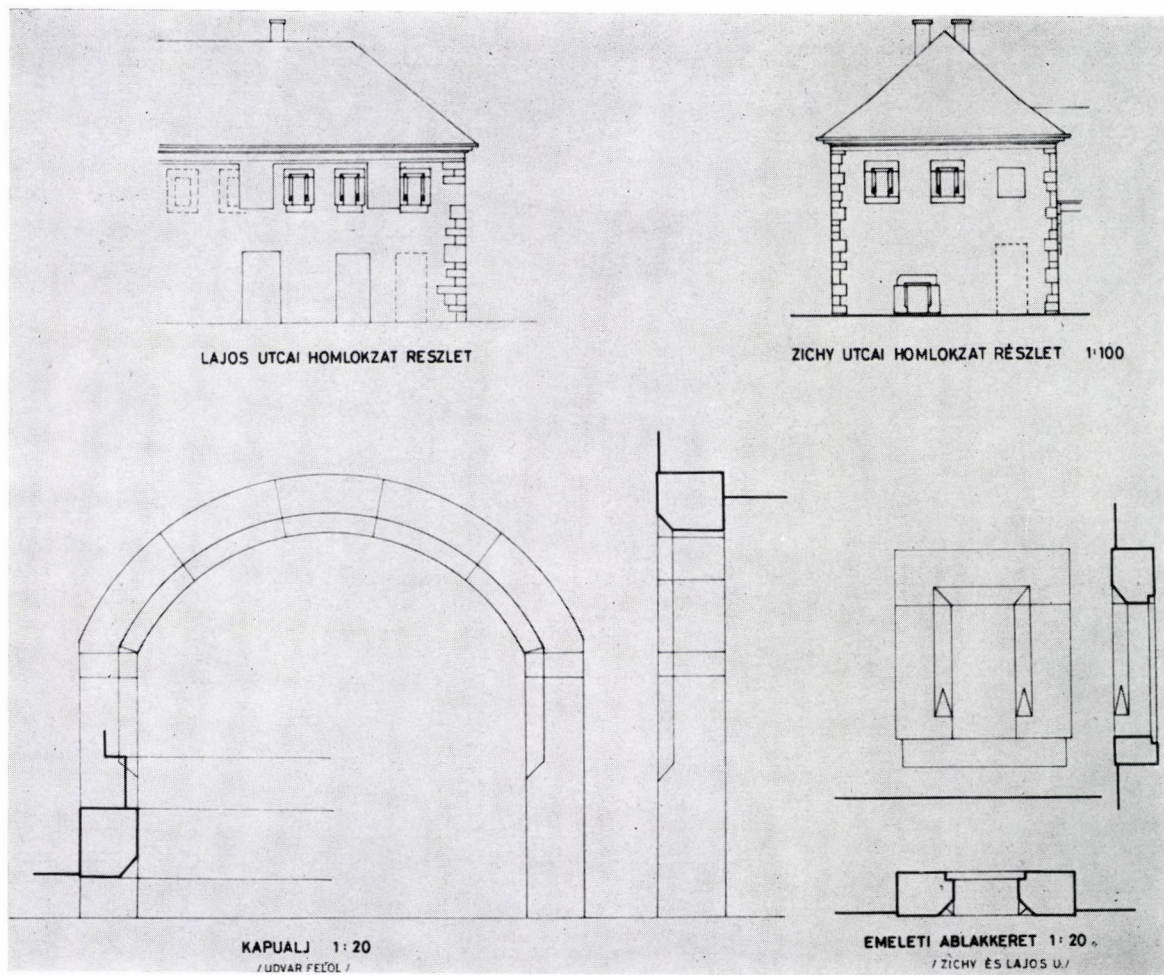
Lajos-Gasse Nr. 158 Vermessung der Fassade mit den mittelalterlichen Details
